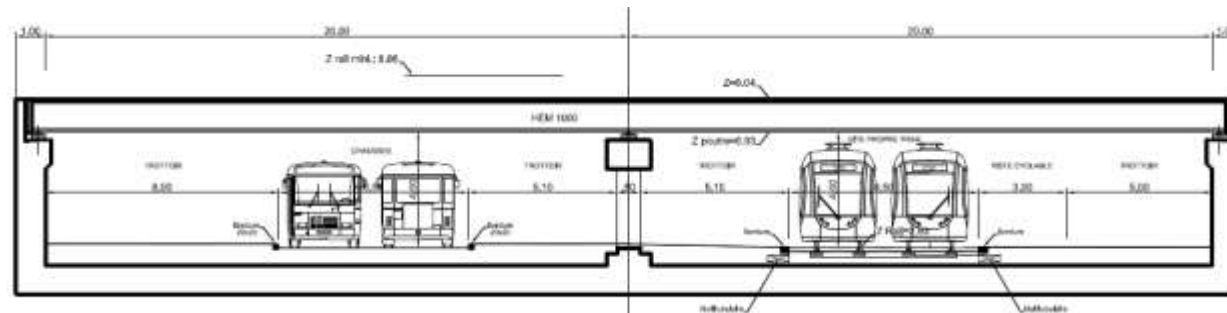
Coupe d'insertion du tramway dans l'ouvrage futur
